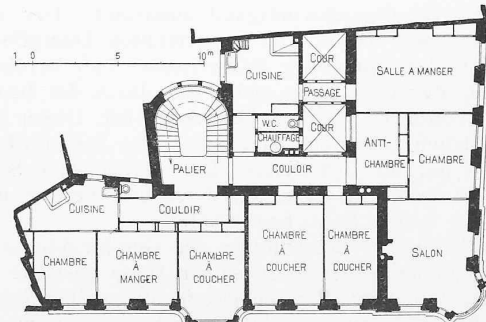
Maison Wolfrath. — Plan du premier étage. — 1 : 400.
